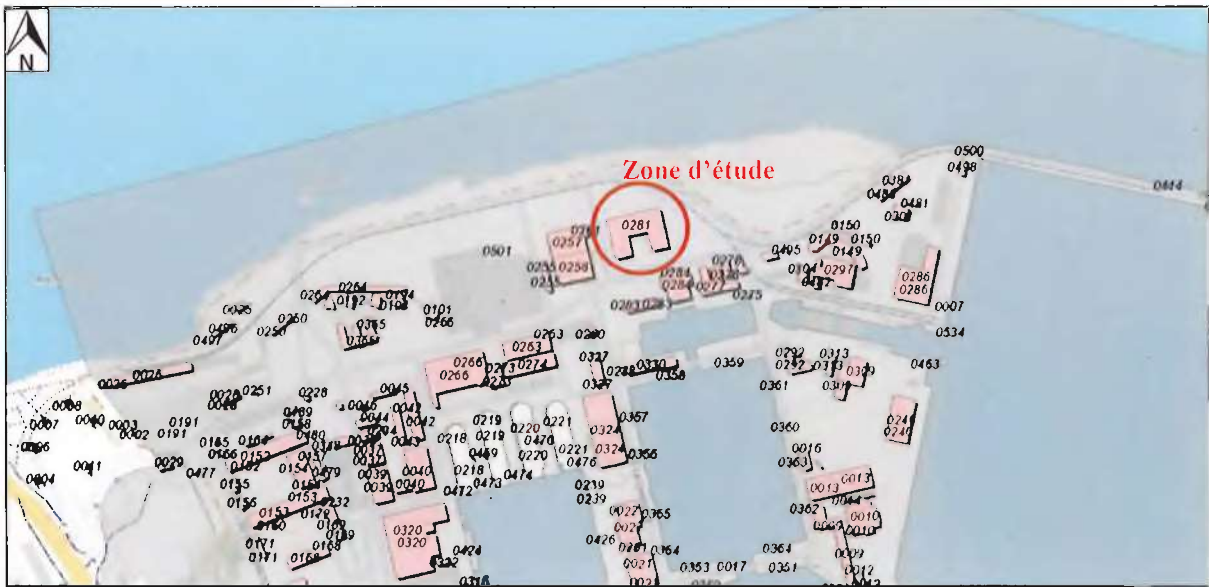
Plan de localisation des travaux – Source : SD-S2P / SPP
